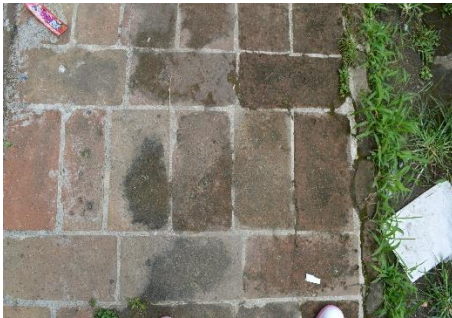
Detalle pisos sobre jardín y cunetas en fachada principal /fuente consultor
